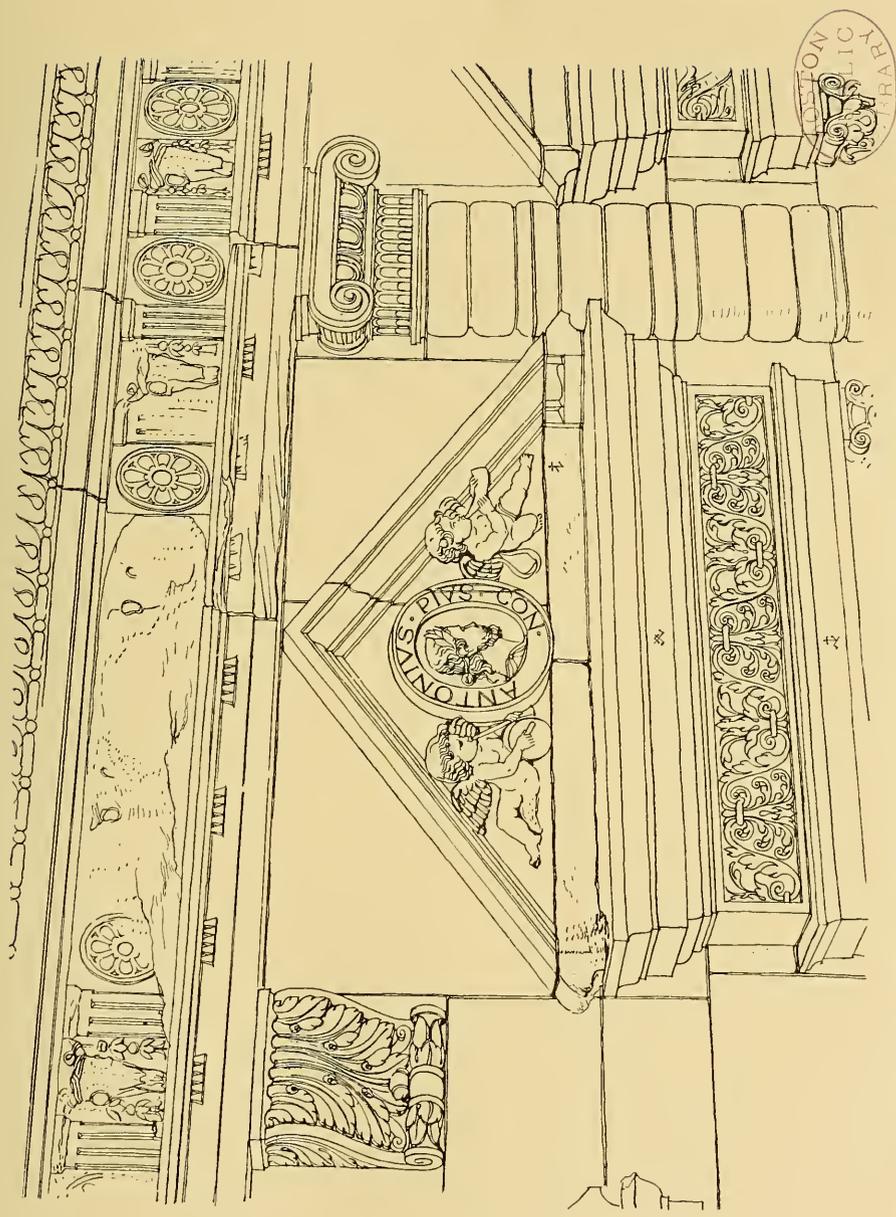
Fenster-Verdachung und Gebälk im Hauptgeschoße des Otto-Heinrichsbau.
